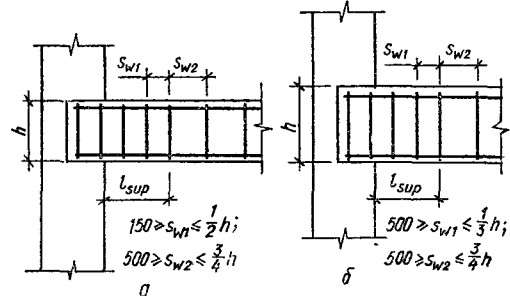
Расположение поперечной арматуры в балках, не имеющих отгибов:
